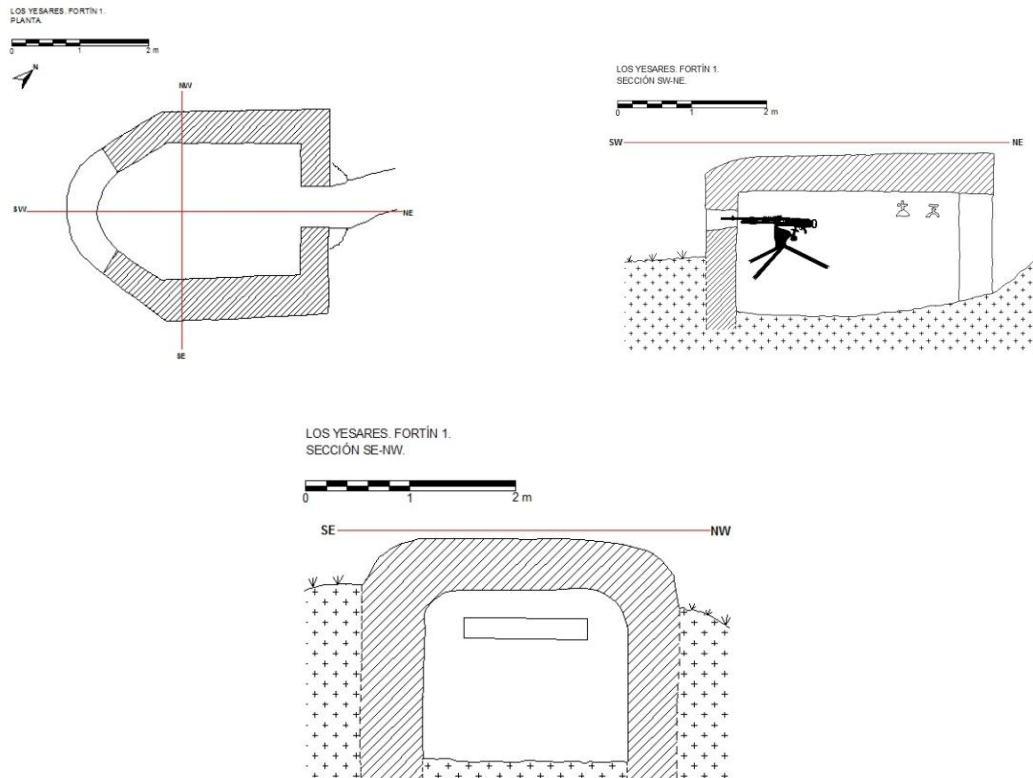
Ejemplo de planimetrías de planta y secciones a escala
